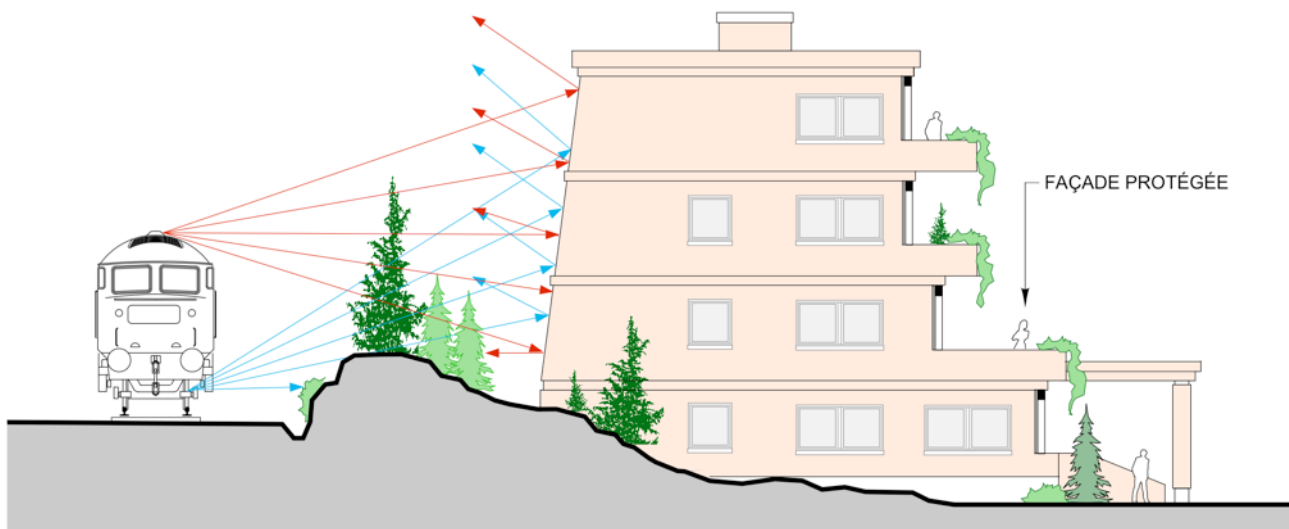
b : Exemple d'une façade close pour éviter la propagation du bruit d'une voie de chemin de fer
